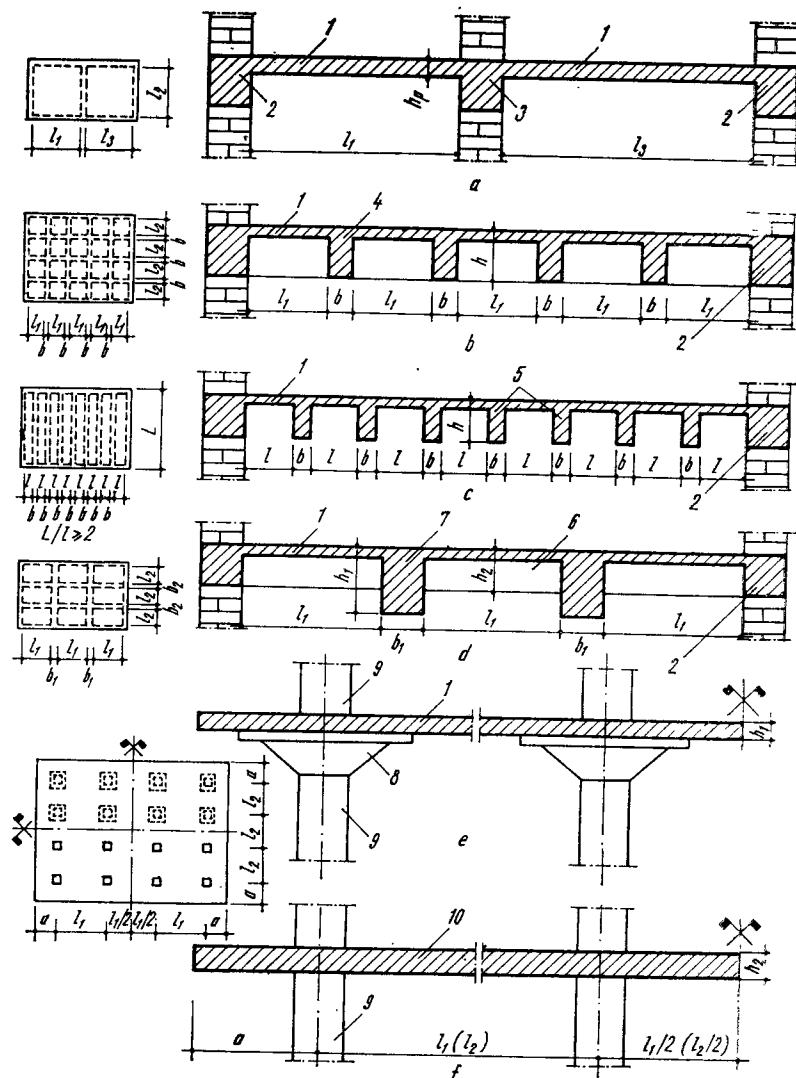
Plan și secțiuni pentru diverse tipuri de planșee din beton armat monolit :
